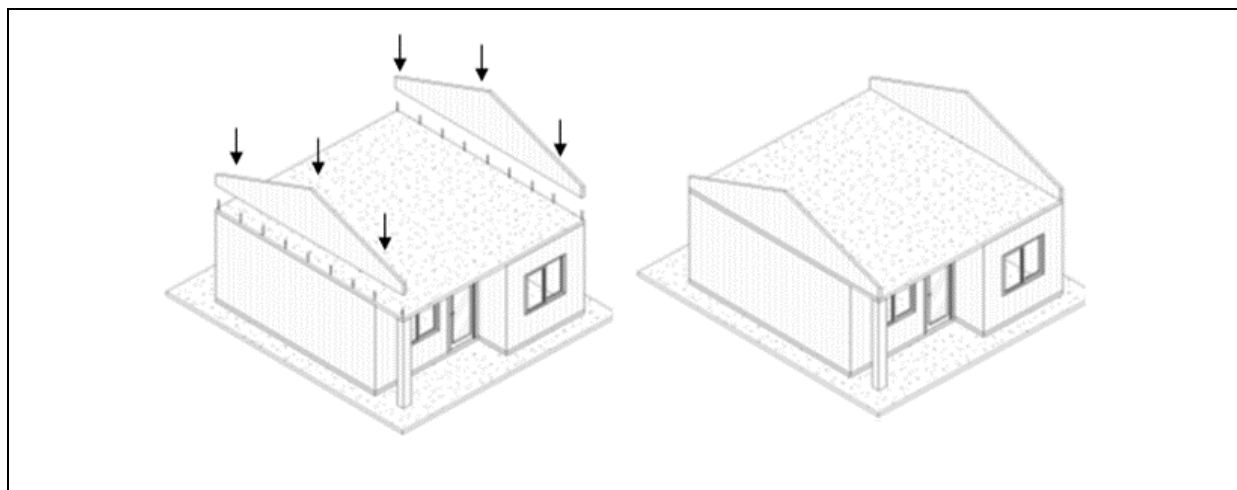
Ilustração da montagem do oitão sobre a laje de concreto. (Sem escala).
